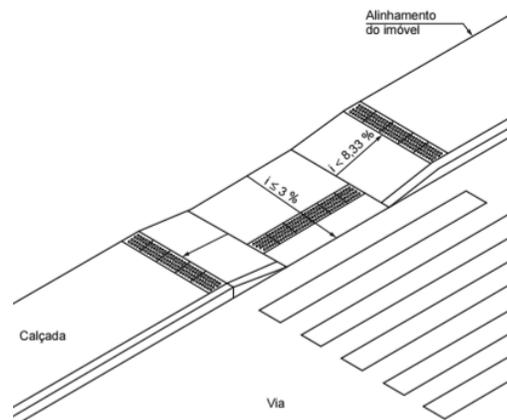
Rebaixamentos de calçada entre canteiros (em metros)
